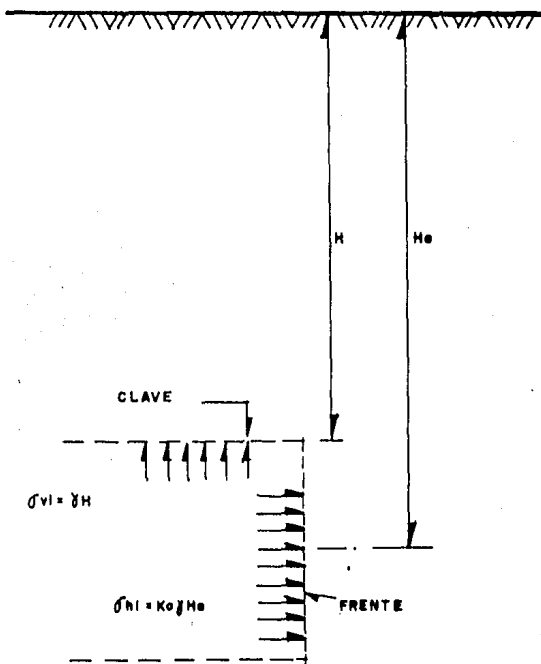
PRESIONES VERTICALES Y HORIZONTALES EN LA MASA DE SUELO, ANTES DE LA EXCAVACION DE UN TUNEL.
